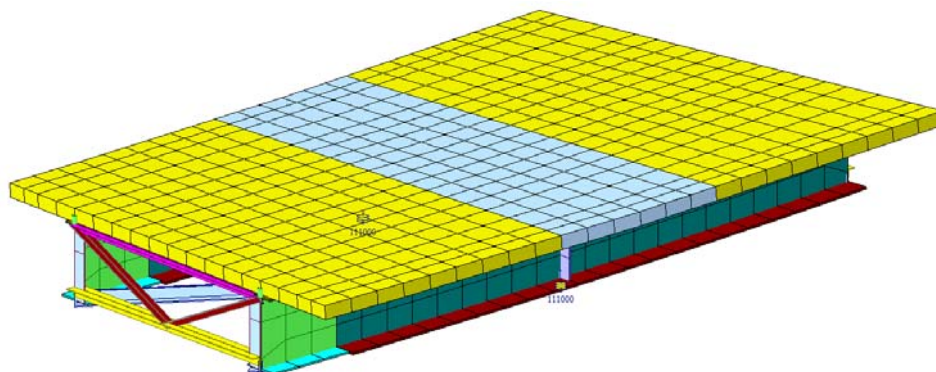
Sovrappasso di ingresso - Modellazione soletta fessurata
